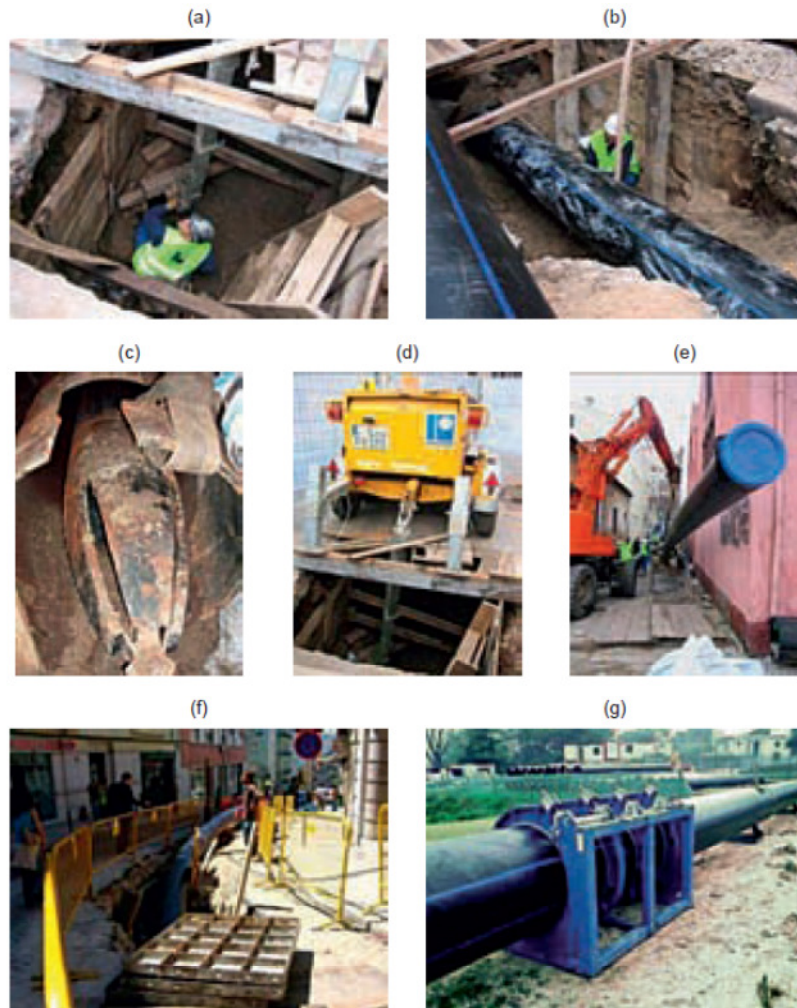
Entubamento com tubagem contínua: (a) poço de acesso; (b) lubrificação da conduta a inserir; (c) ponta de inserção - tracção; (d) equipamento de tracção; (e),(f) inserção da conduta; (g) execução da soldadura entre tubos. ([www.ludwigpfeiffer.com](http://www.ludwigpfeiffer.com))
